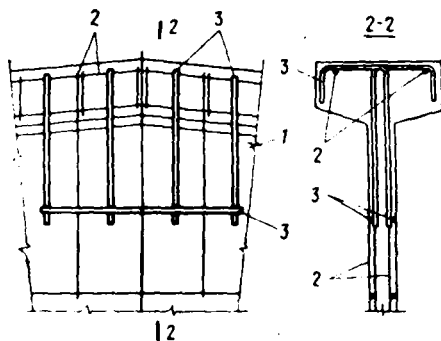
Форма отверстий в стенках стропильных балок и примеры их армирования
